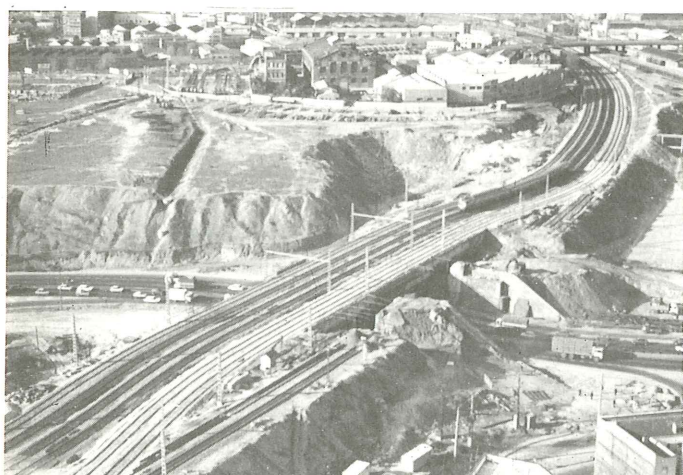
Traslado de las vías de Barcelona y demolición estribos puente metálico.
